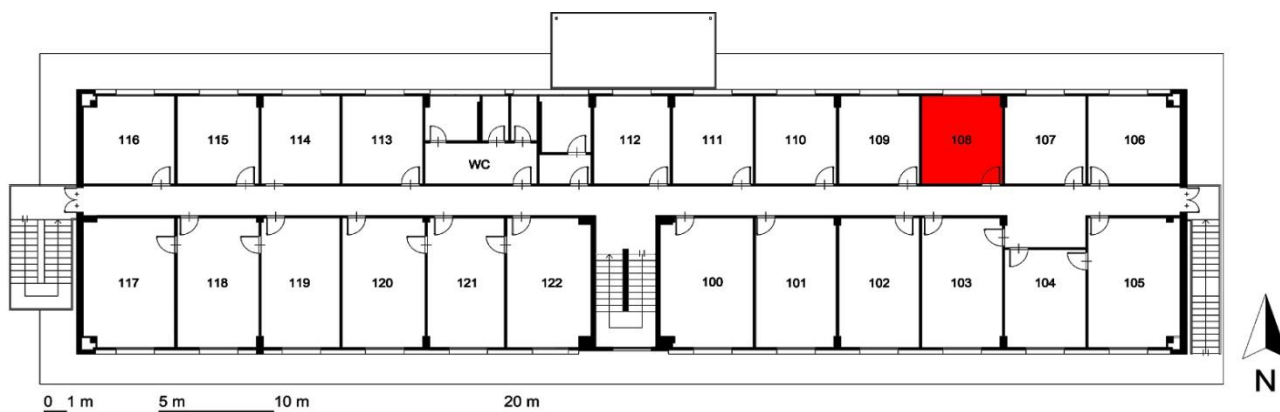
Planimetria dell'edificio F51 del Centro Ricerche Casaccia dell'ENEA.
